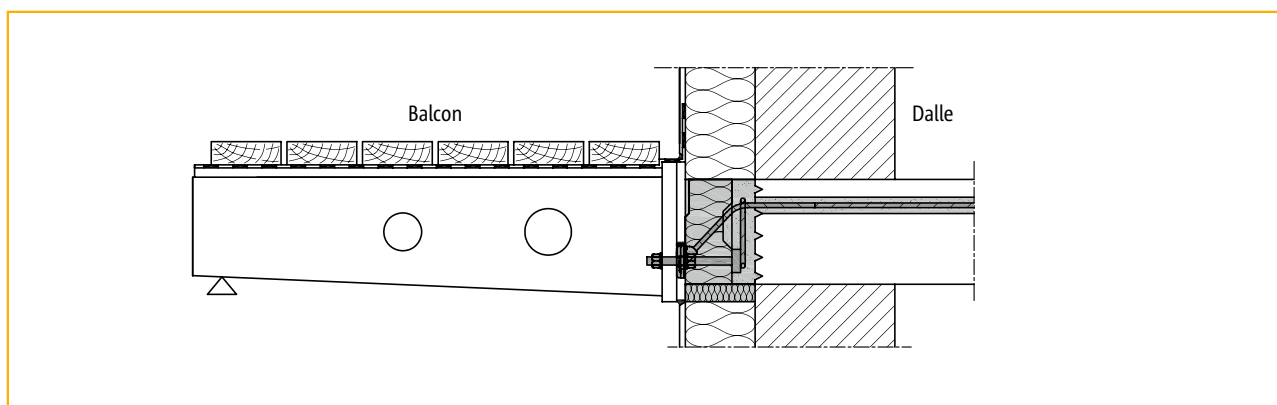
balcon sur poteaux pour la rénovation d'un balcon existant
